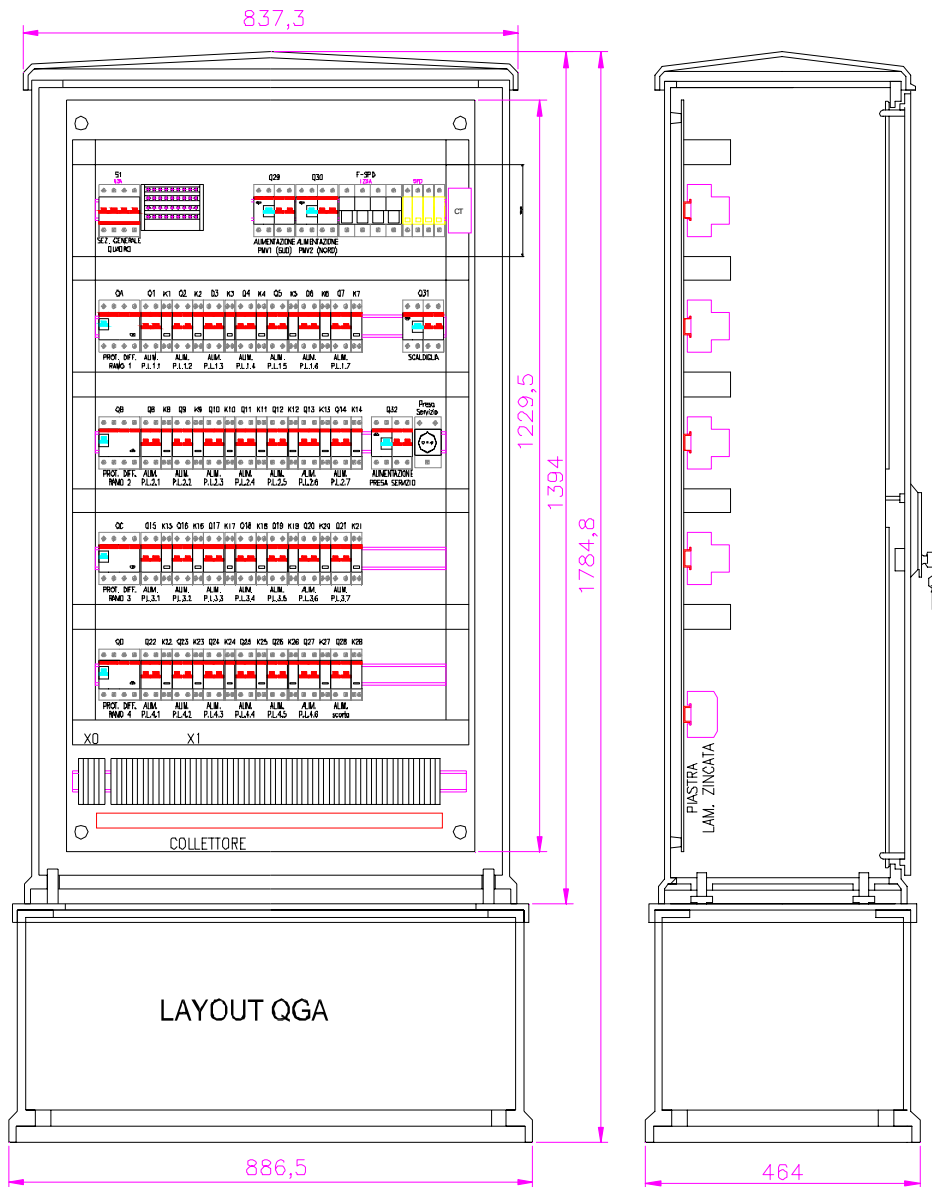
Layout QGA Quadro alimentazione servizi rotatoria
